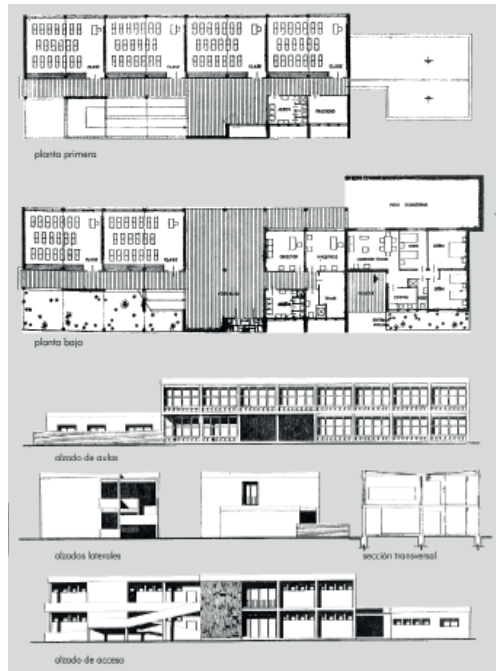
Prototipo de escuela graduada de Fernández-Huidobro y Pintado. Planta baja y primera, alzados y sección.
